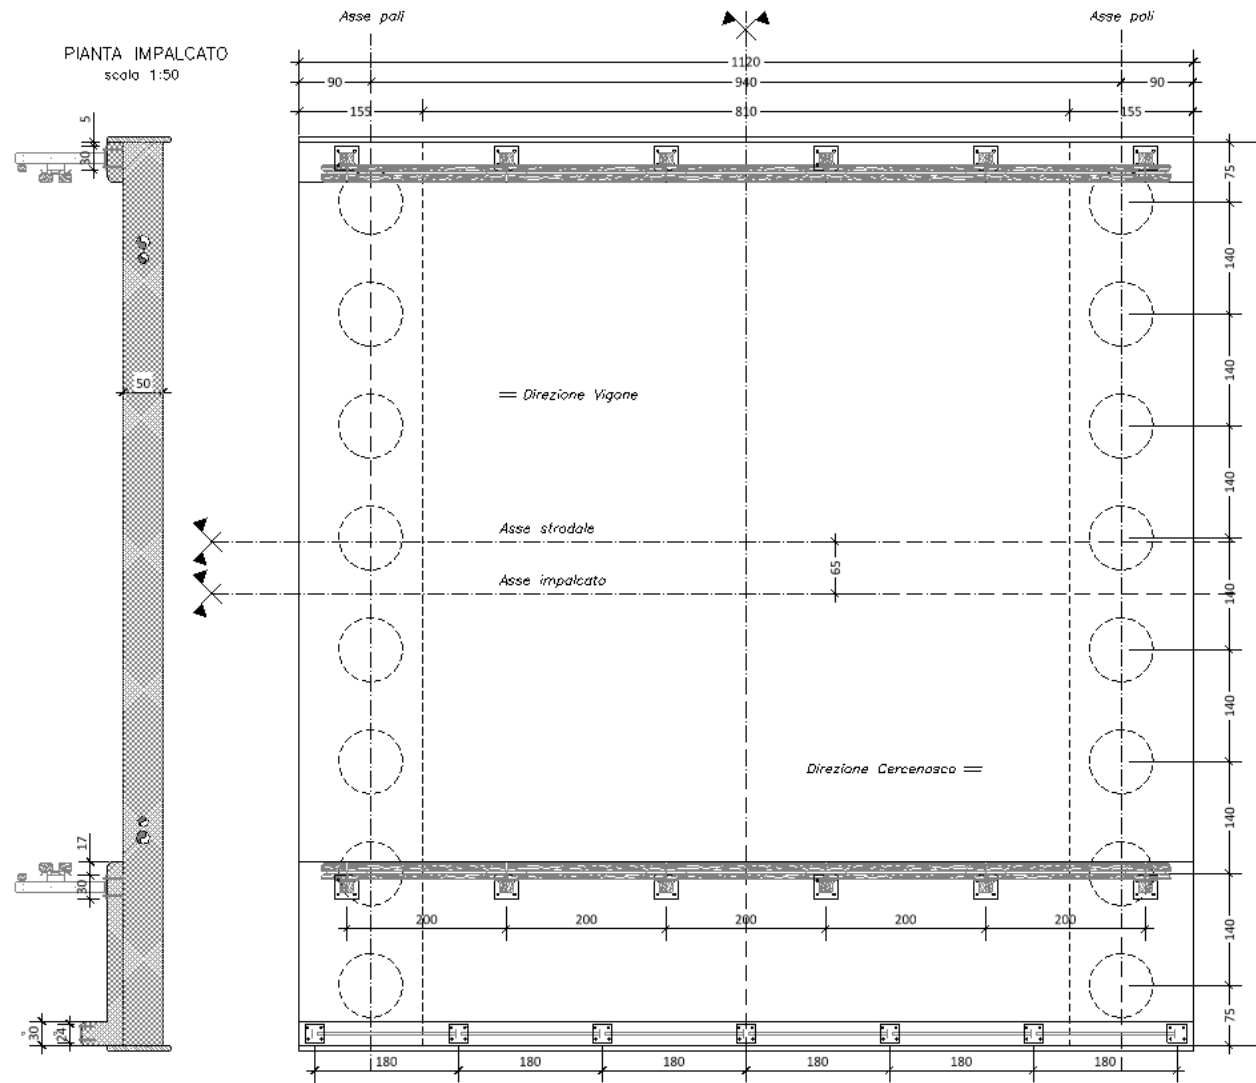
Pianta impalcato/pali di fondazione e sezione trasversale all'asse stradale
